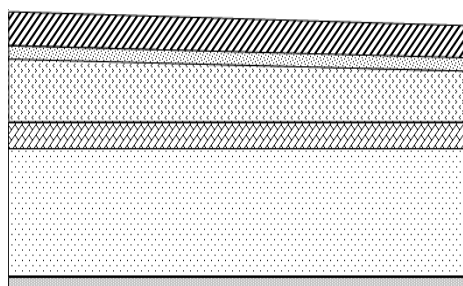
Coupe verticale du plancher terrasse à dalle pleine.
